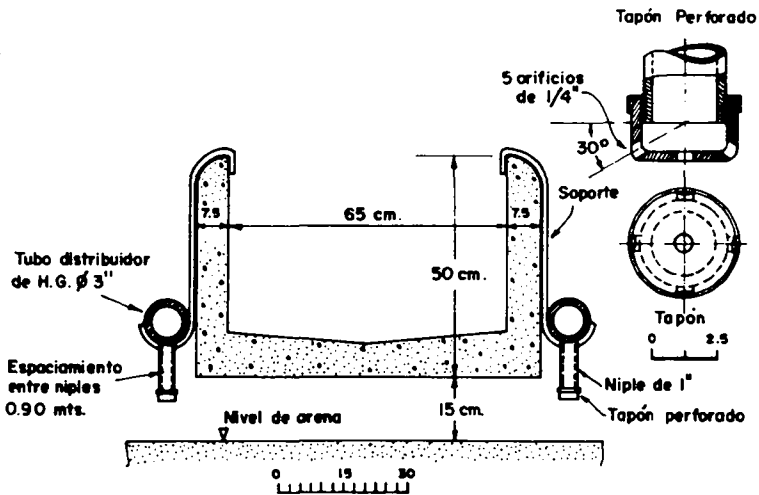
Lavado superficial en la planta del distrito sur de Chicago (según Baylis).
